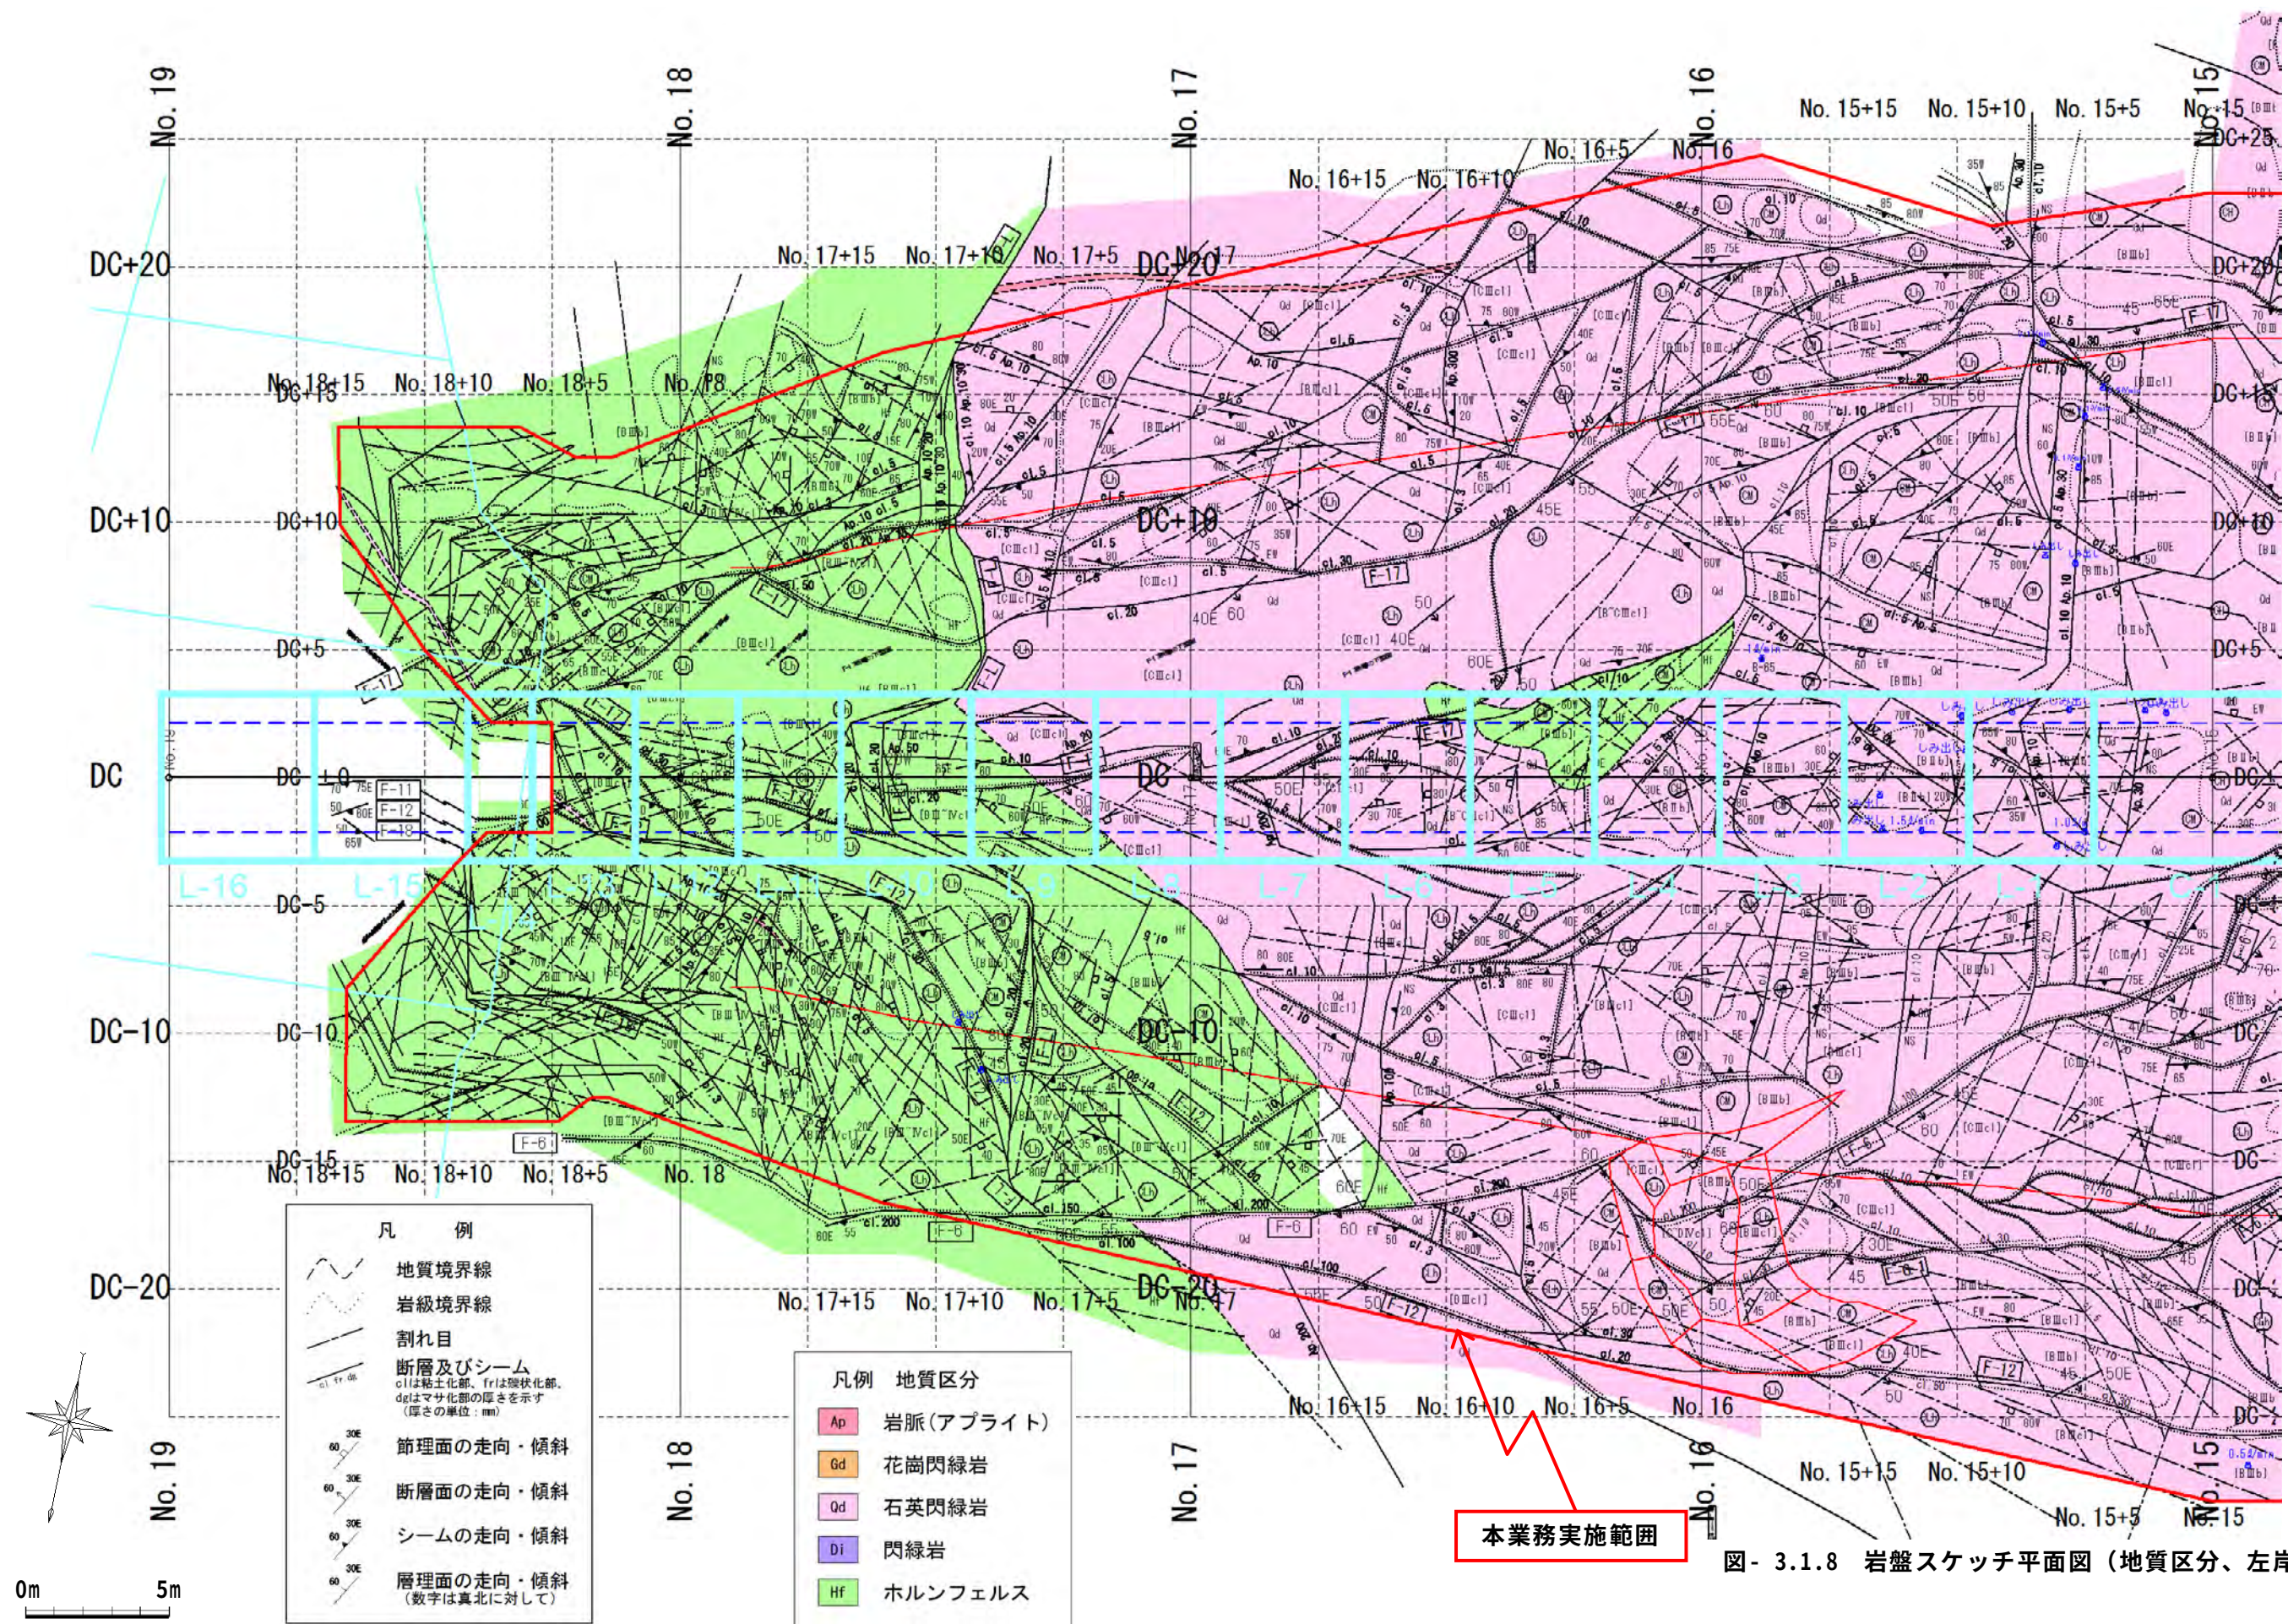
岩盤スケッチ平面図(地質区分、左岸部)
